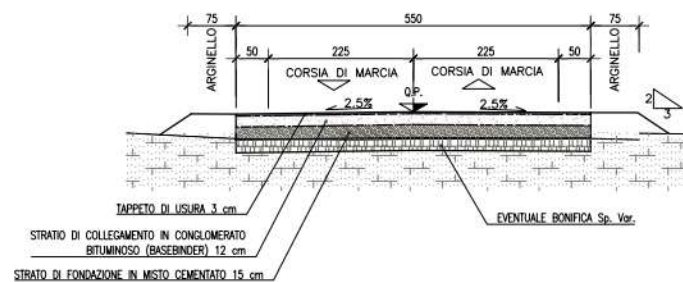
Sezione tipo complanare 5,5 m in rilevato
